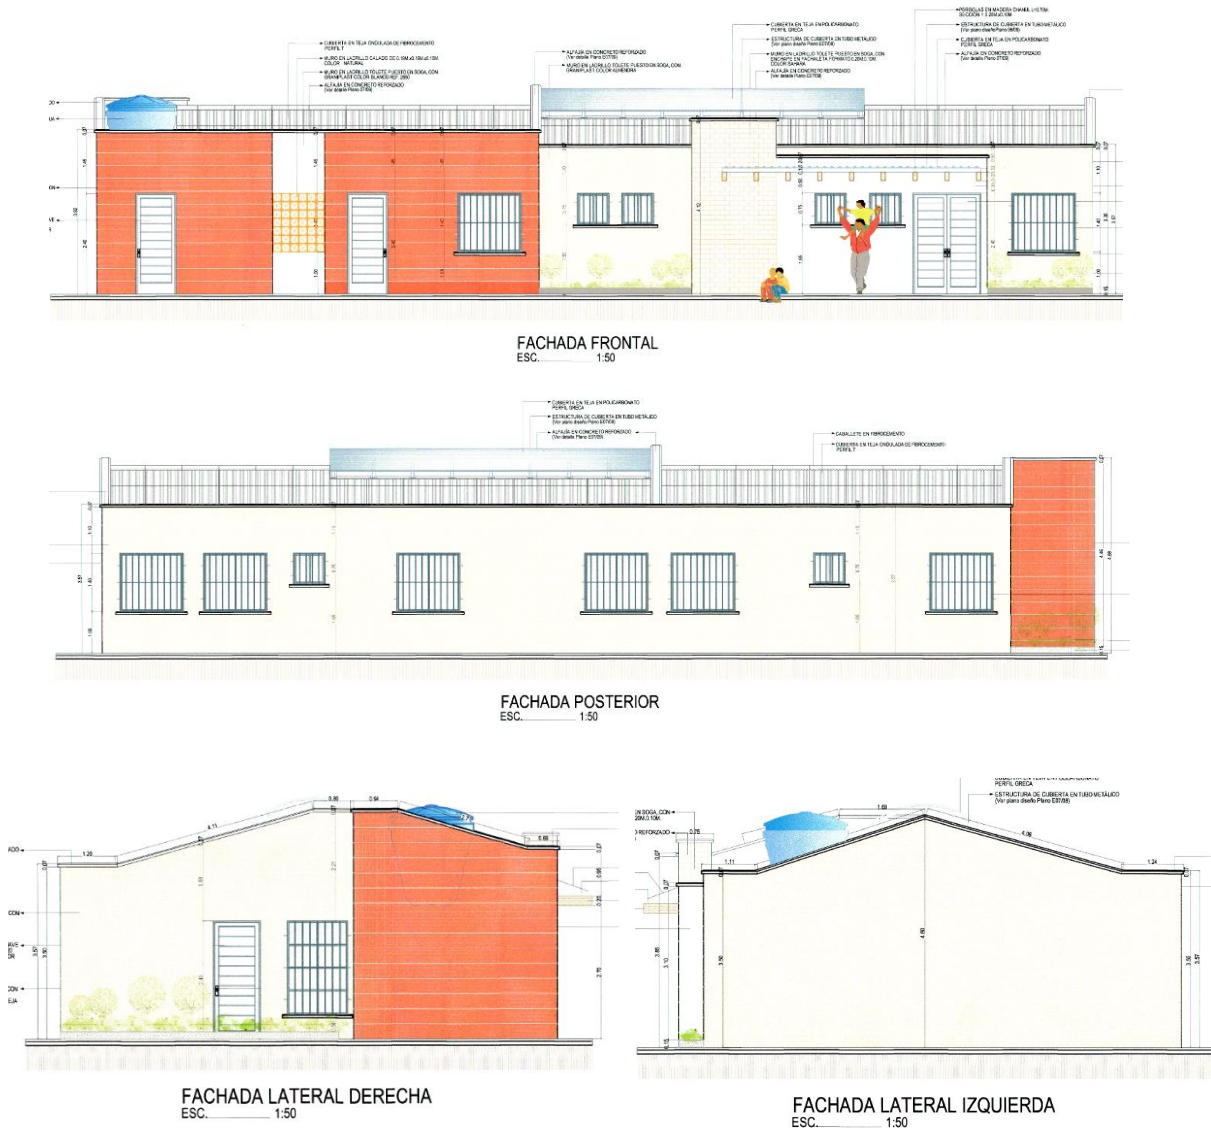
Planos arquitectónicos- Fachadas del establecimiento de salud de Chinas
